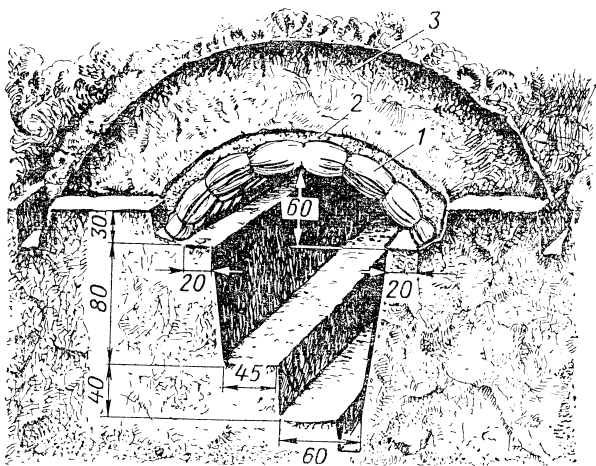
Укрытие в глинистых грунтах с покрытием из камышовых арочных фашин:
